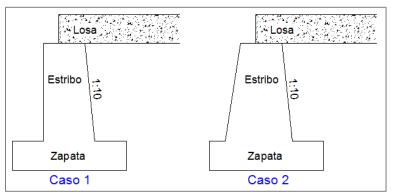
Estribos de concreto reforzado, Ilustración, 2018
